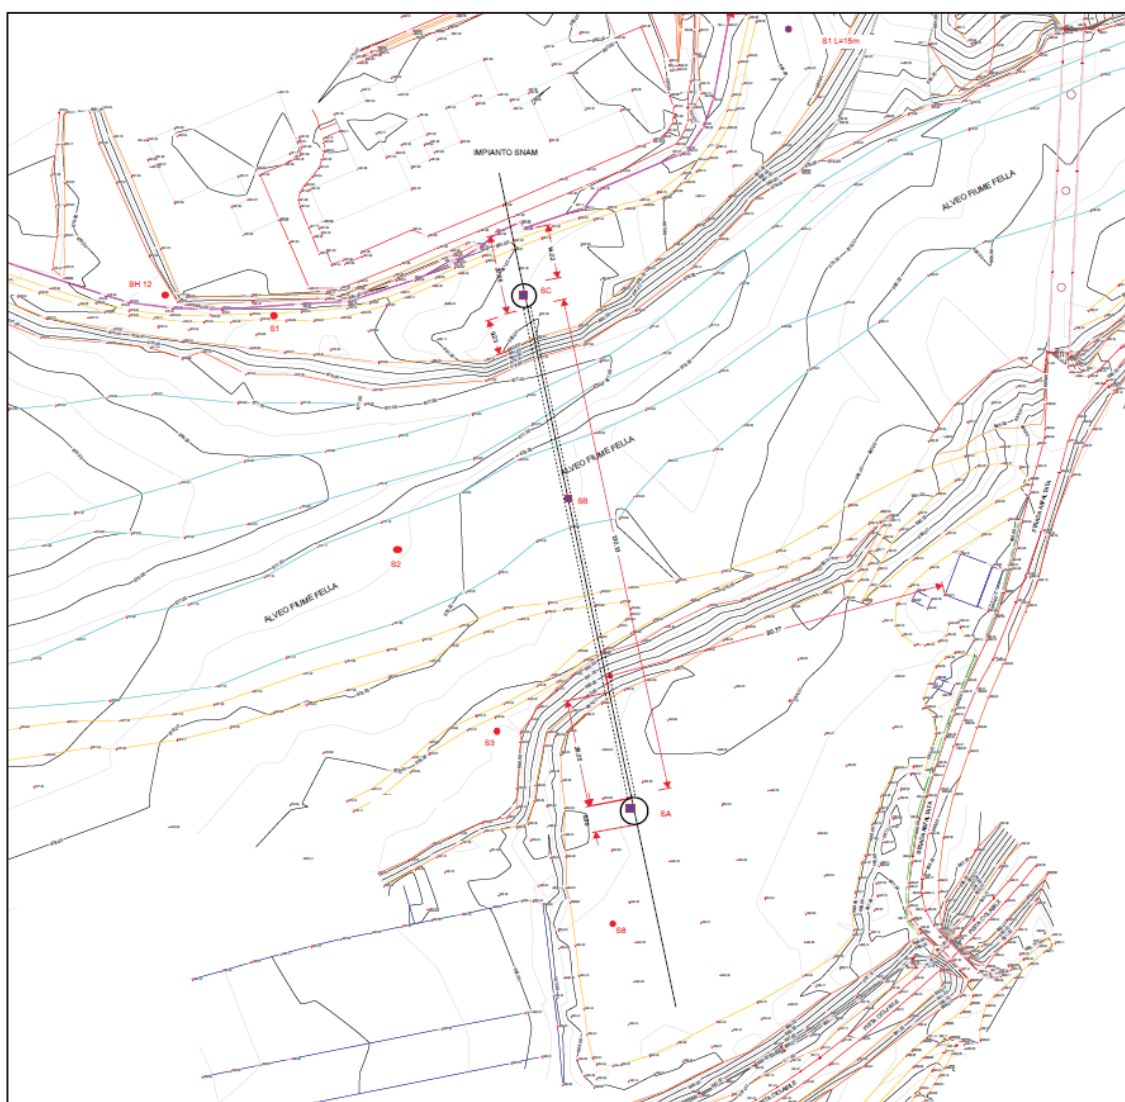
/A – Stralcio planimetrico con l'ubicazione del microtunnel e dei pozzi di trivellazione (disegno non in scala)
